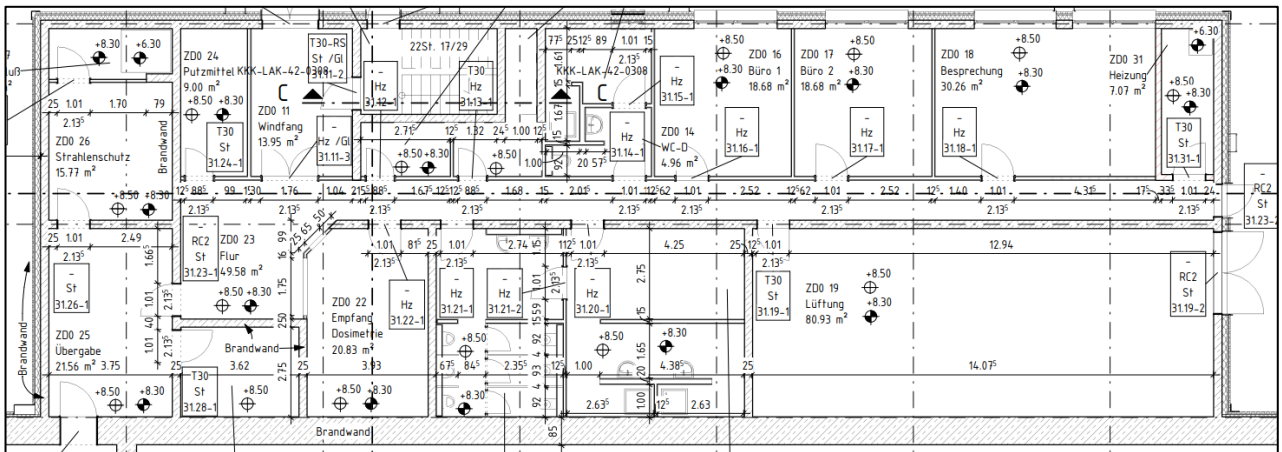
Betrachtetes Gebäude - Grundriss Funktionsgebäude - Erdgeschoss
